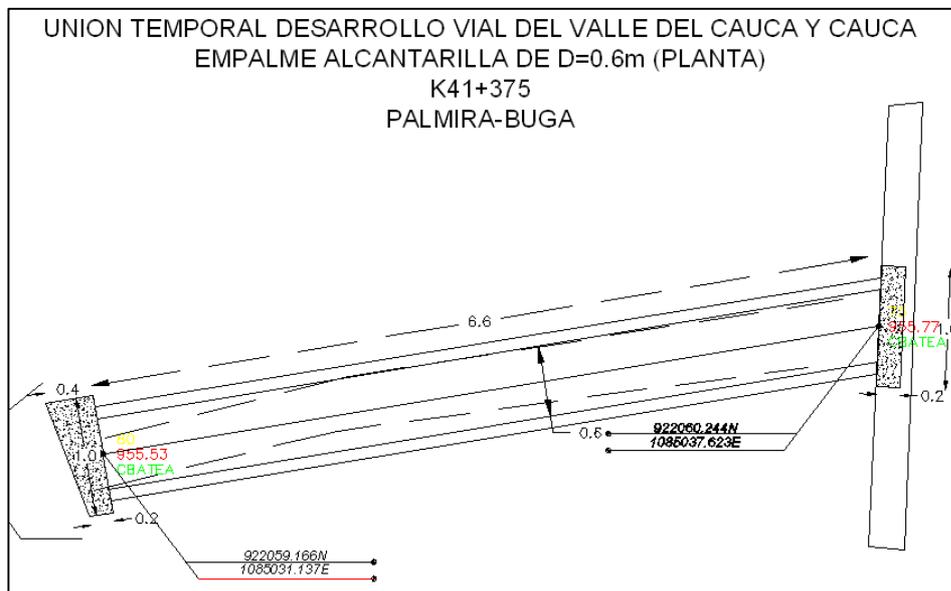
Planta alcantarilla doble Km41+331 – Km41+375
